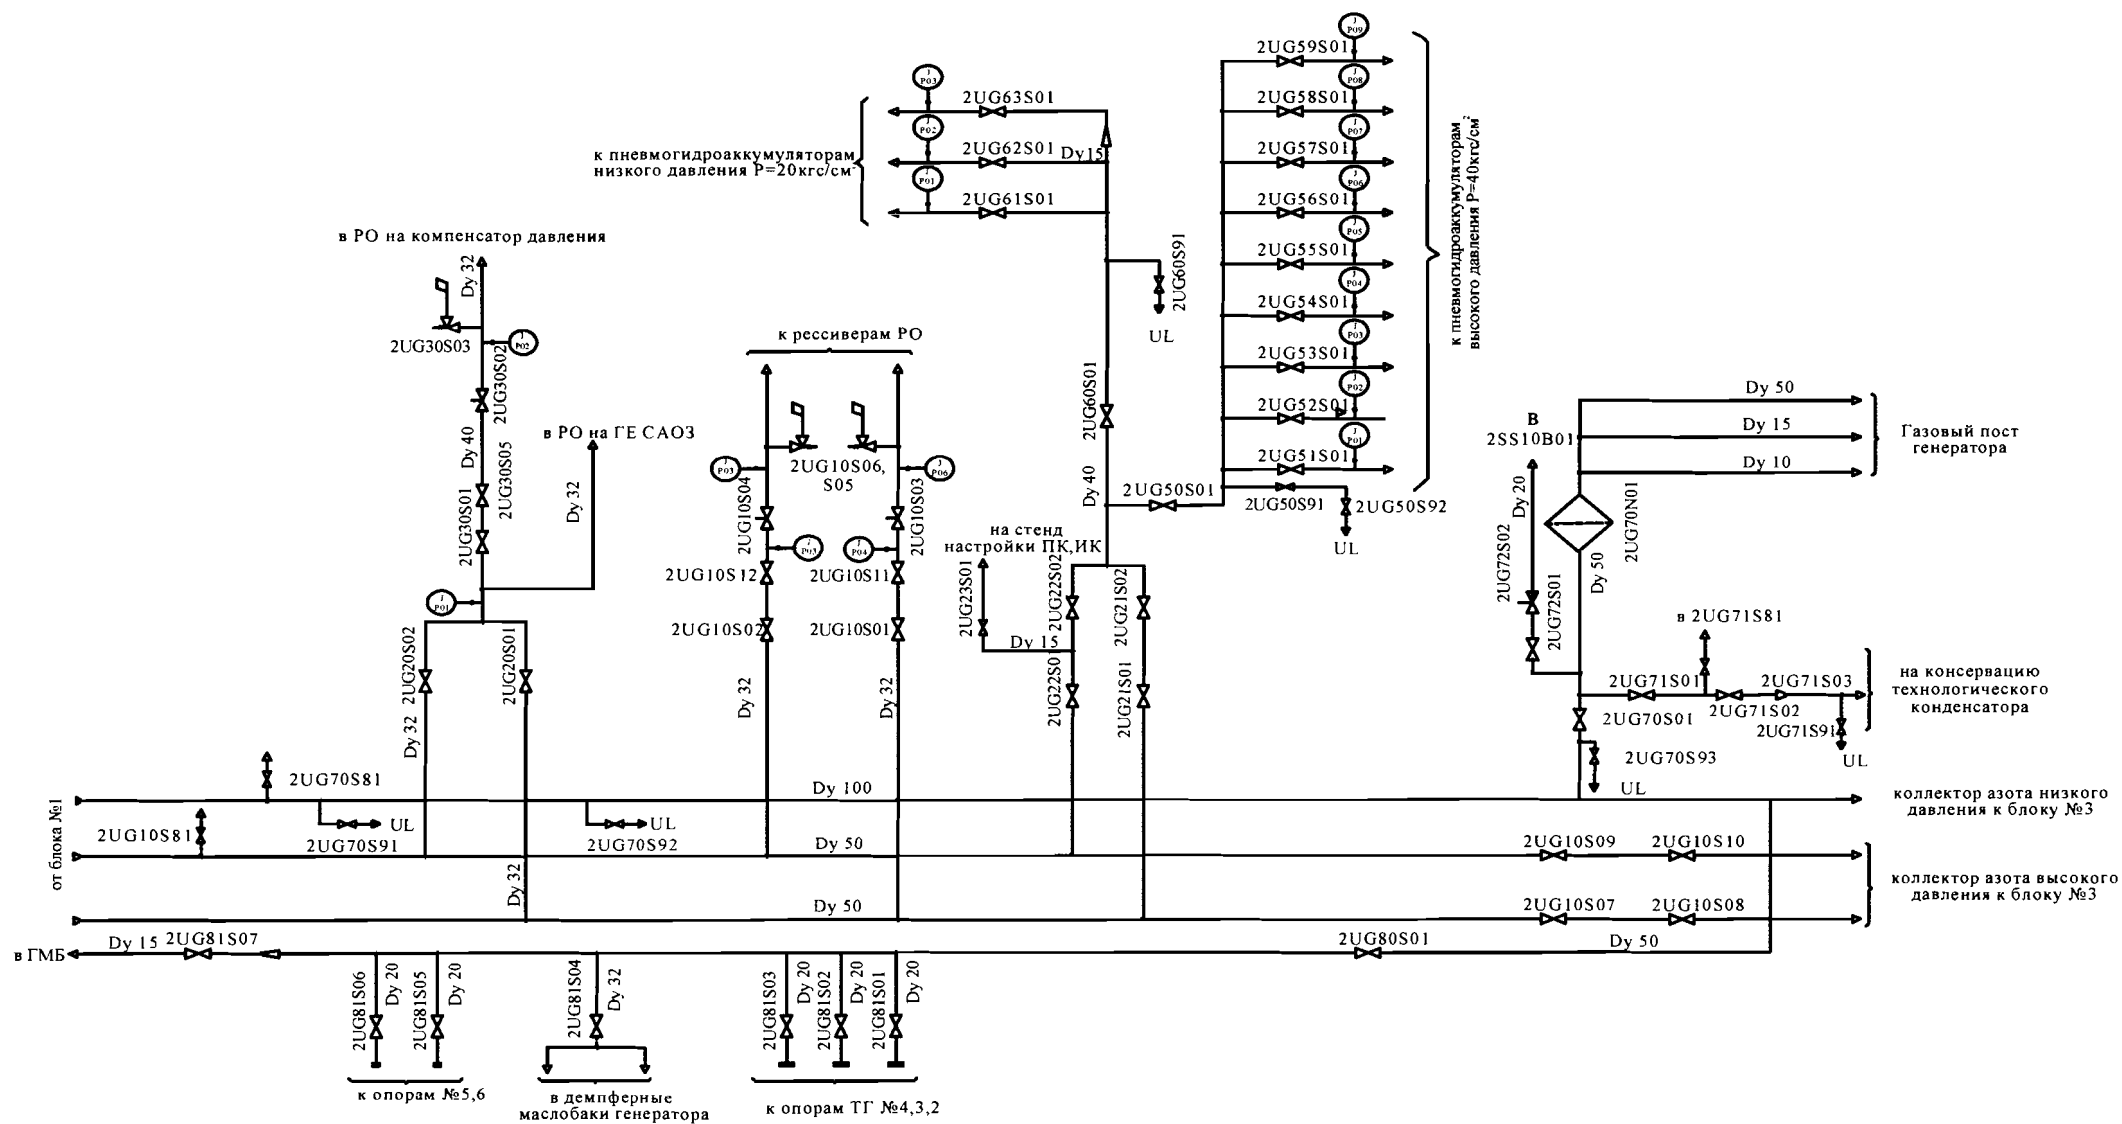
Схема трубопроводов азота машзала блока 2
